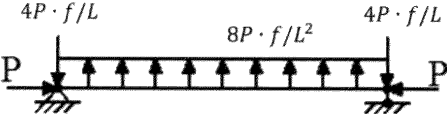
Расчетная схема балки с напрягаемой арматурой:
